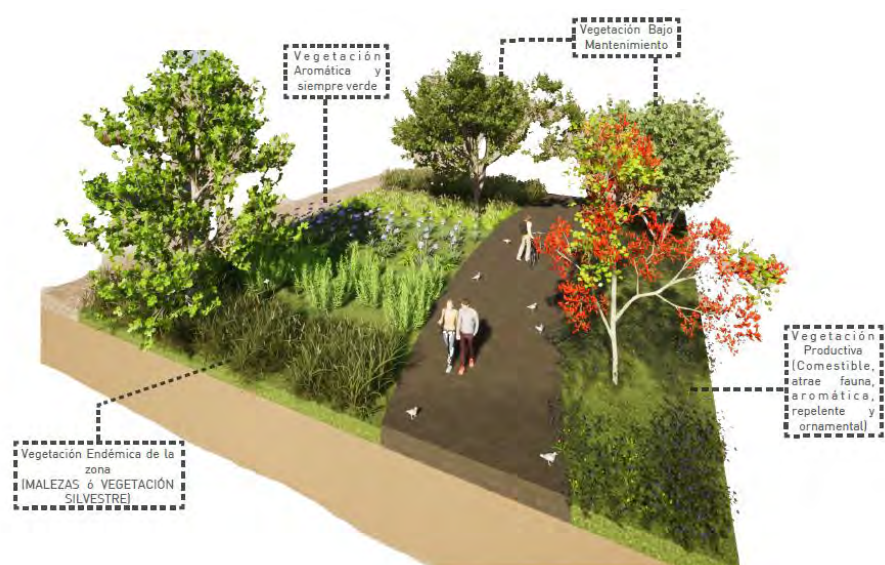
Detalle de Plantación. Fuente Elaboración Propia
